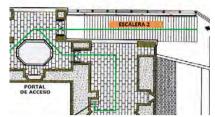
Plano detalle de la ESCALERA 2 que da acceso a la primera planta y recorridos de visita
